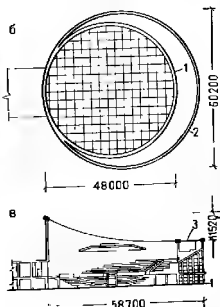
Покрытия с перекрестными несущими вантами (провисающие вантовые сети)
